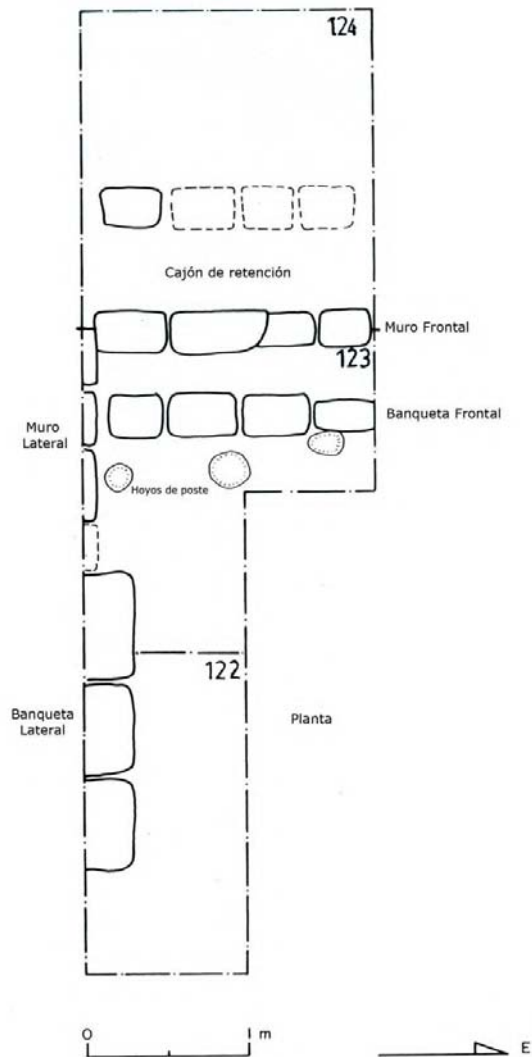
Planta Sub-estructura 4Sub-1, debajo Estructura 4.
